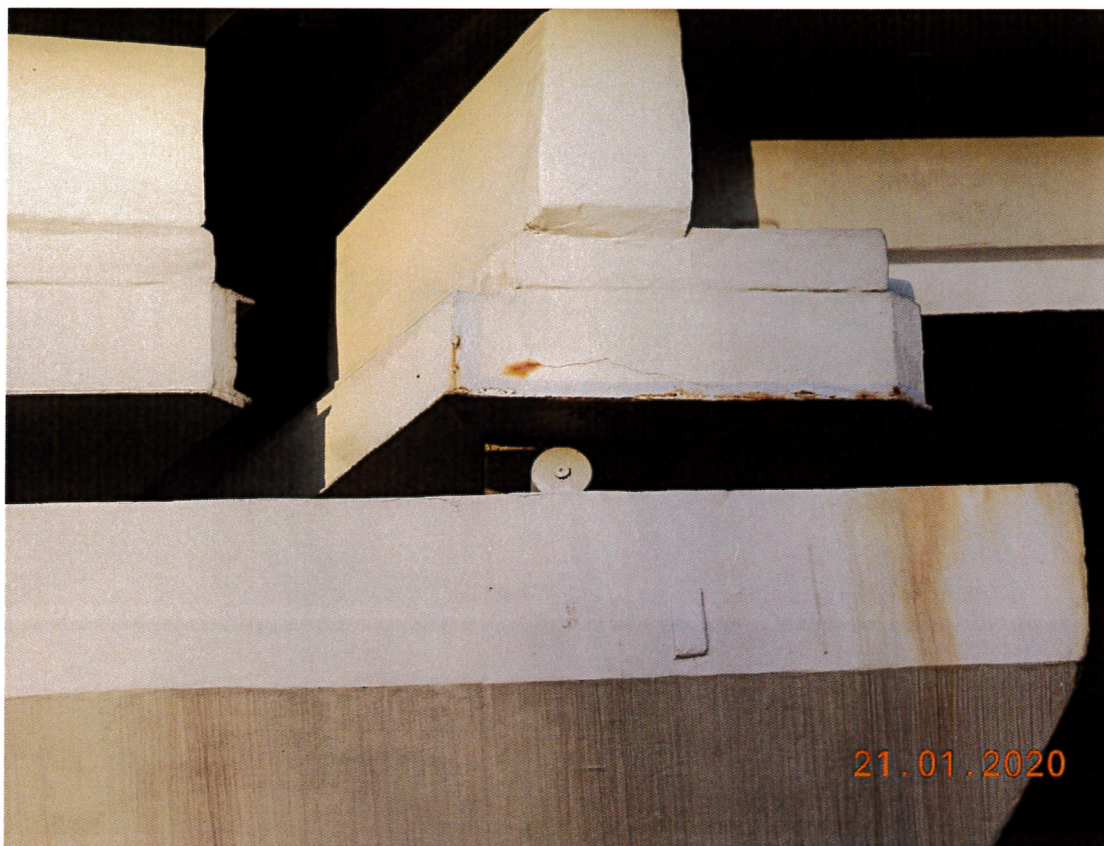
Odspojenie betonu oczepu filara, korozja zbrojenia i betonu
